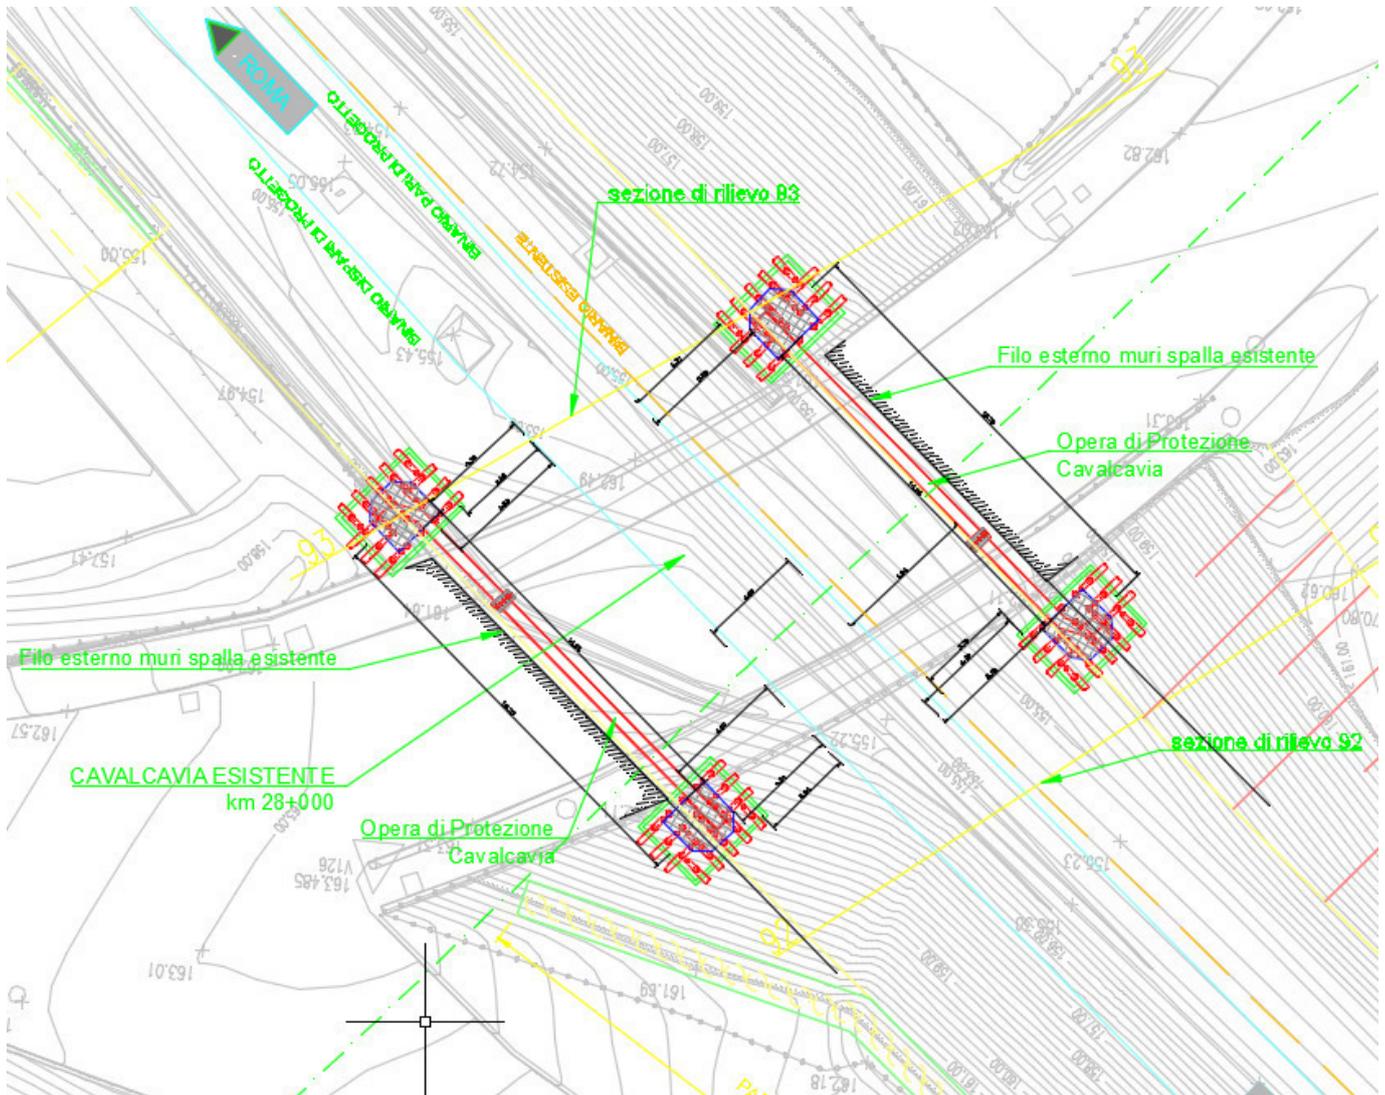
Stralcio planimetrico cavalcaferrovia IV05 con indicazione dell'opera di protezione delle spalle
